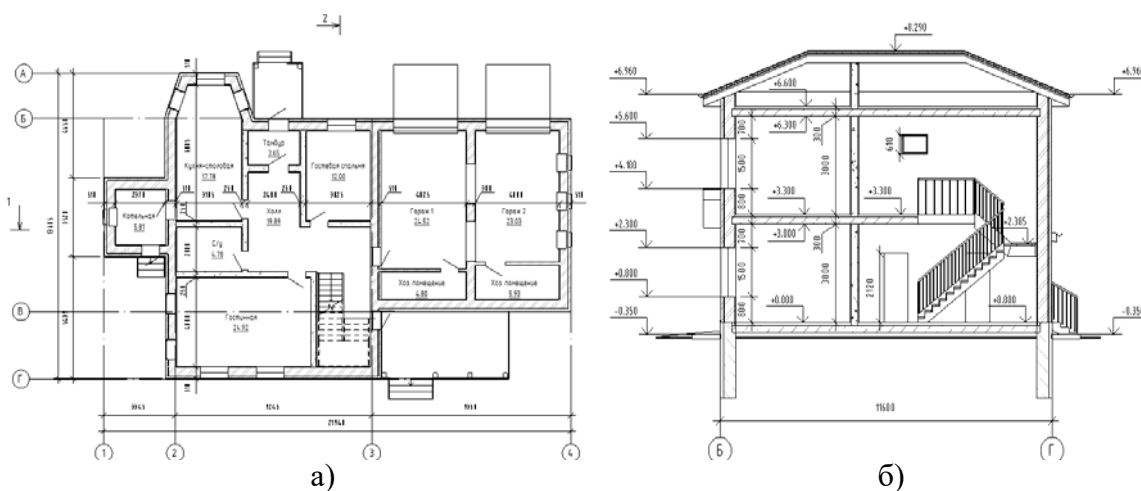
План этажа и разрез жилого дома (вариант 2):
